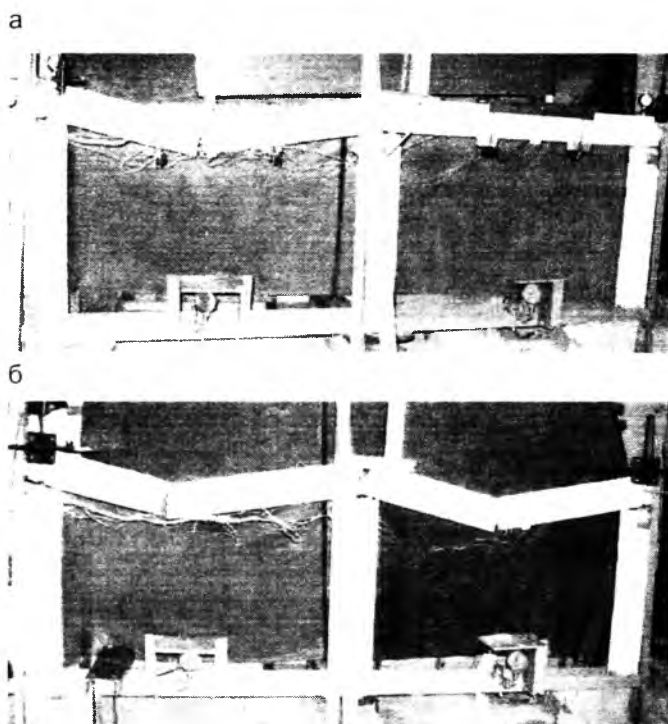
Схемы разрушения первой (а) и второй (б) опытных конструкций рам
